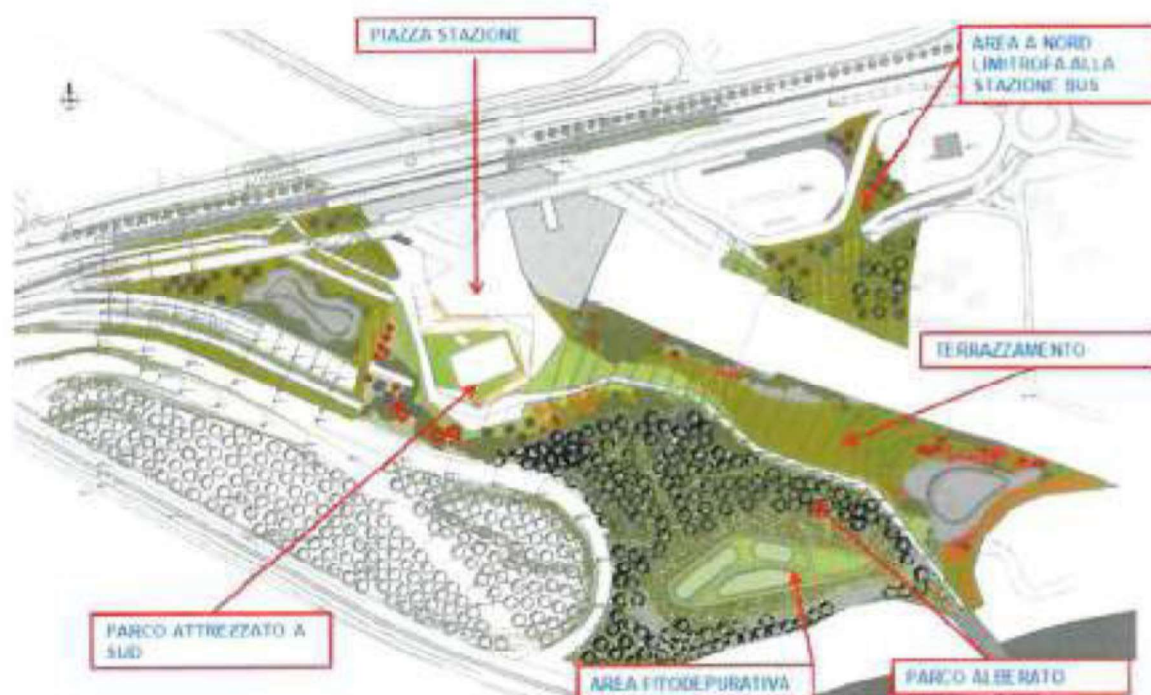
Schema planimetrico delle sistemazioni a verde nell'area della nuova stazione internazionale
